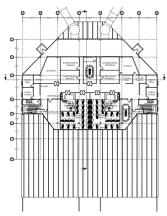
Layout Plan (Sumber: Hasil analisis, 2023)
